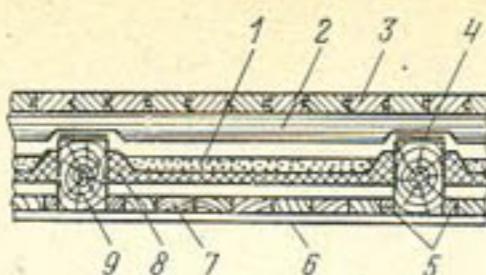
Междуэтажное перекрытие по деревянным балкам:
